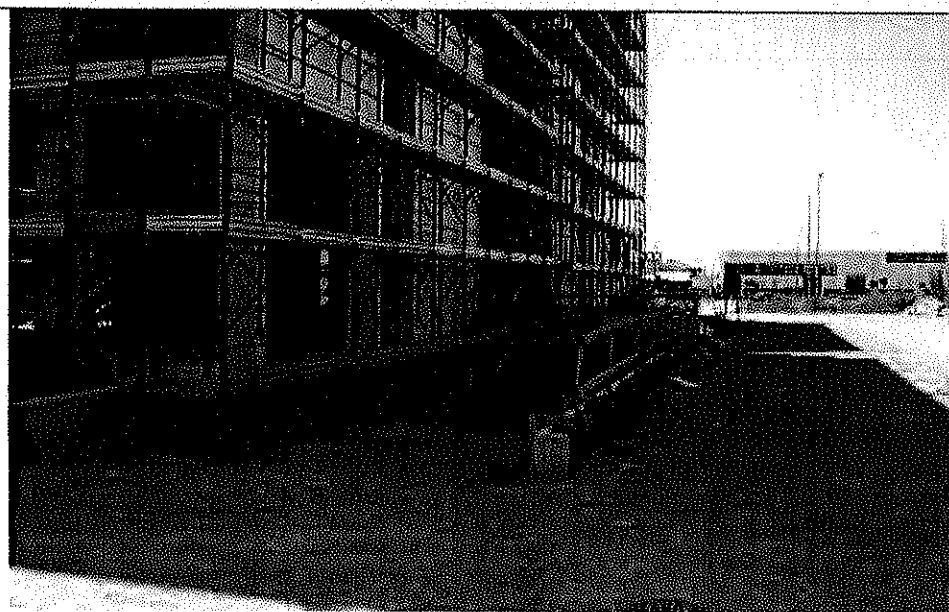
Vista verso la rampa di accesso al piano interrato dell'hotel, ove sono ricavati gli spazi per i box ed i locali a servizio dell'hotel.
